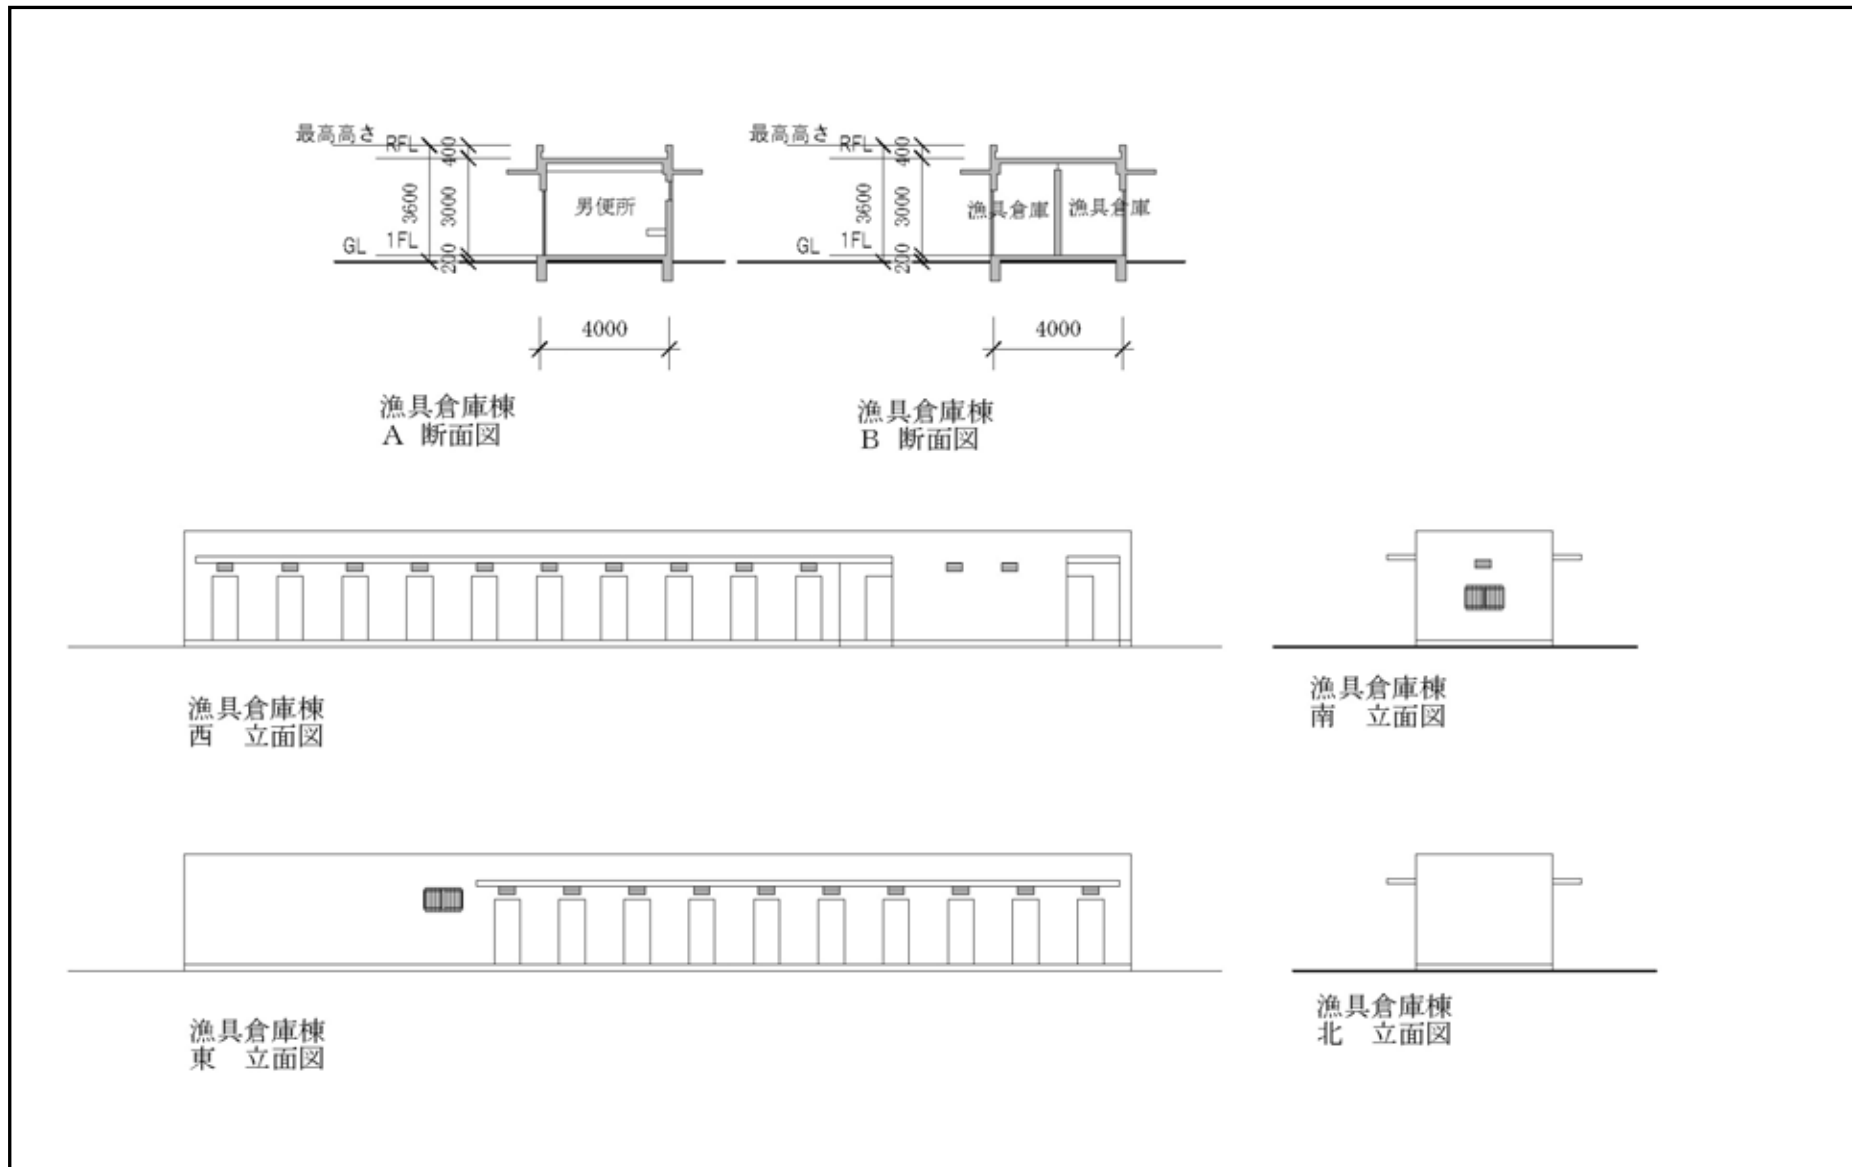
(16) 漁具倉庫棟の断面・立面図
